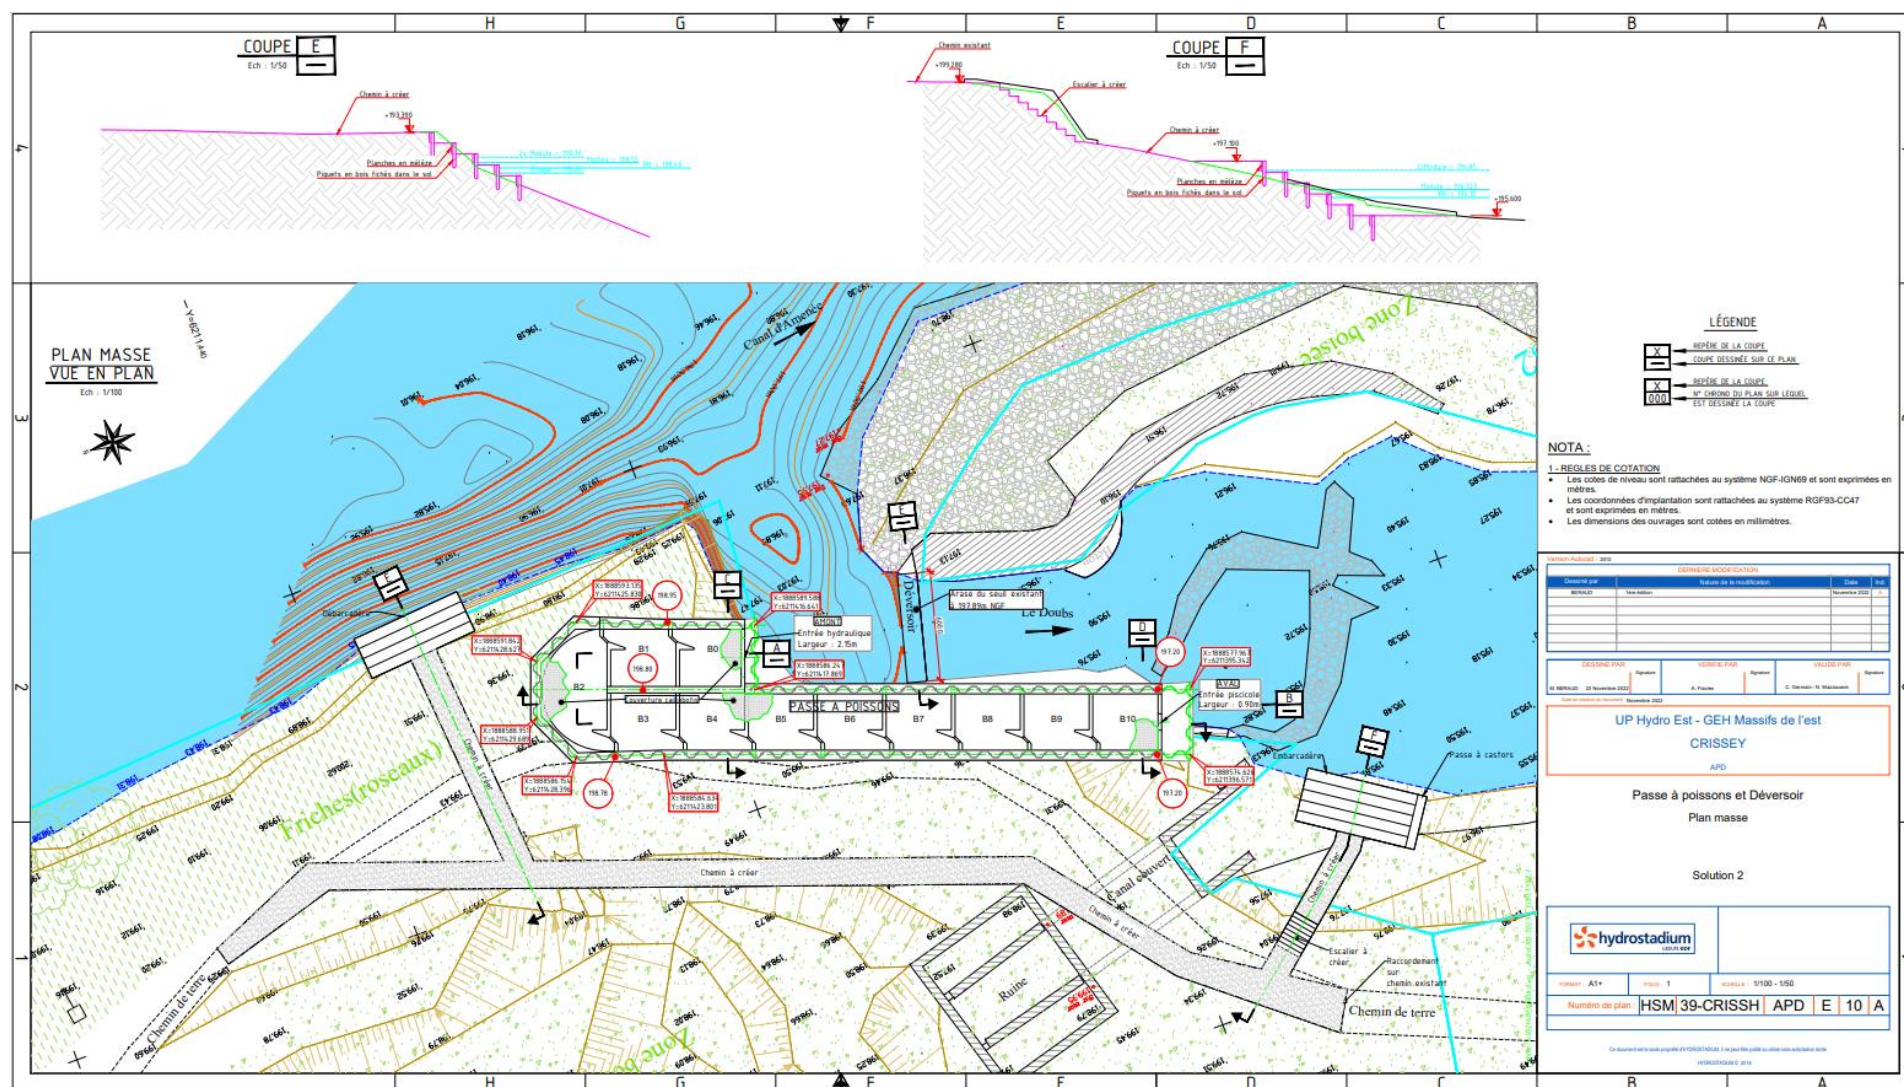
Plan masse du projet (transmis par EDF en janvier 2023)
